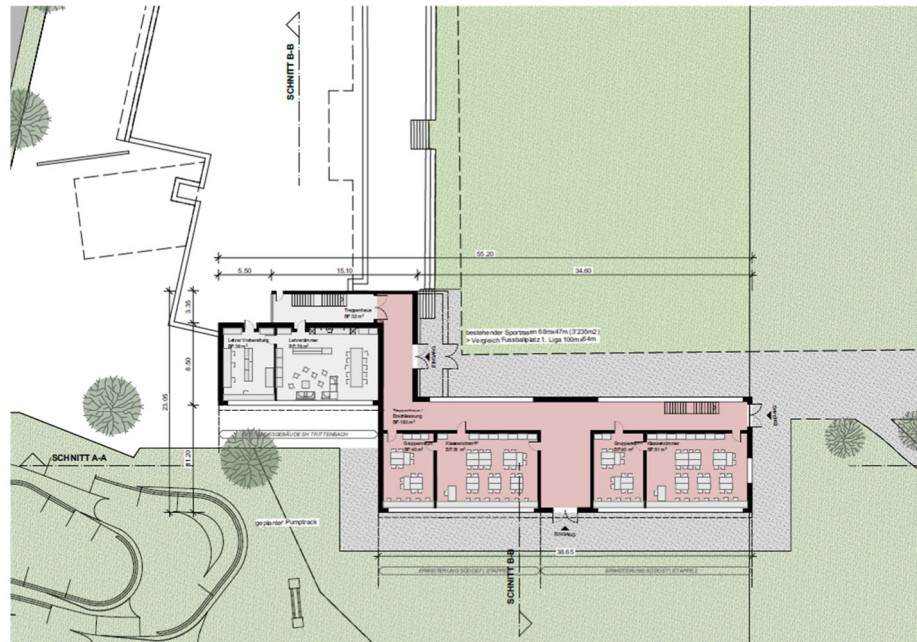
Disposition 02 | Grundriss Erdgeschoss
